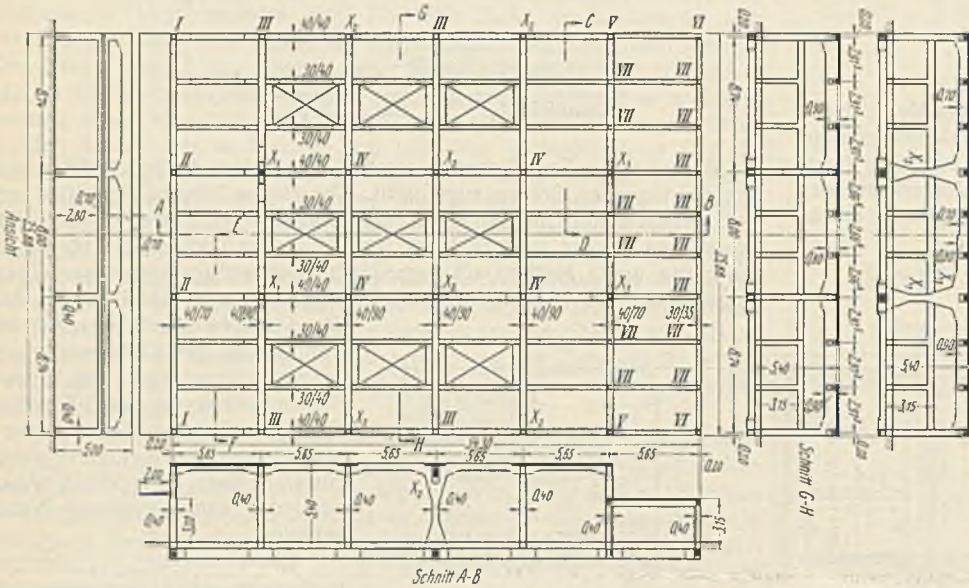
Schalungsplan, Grundriß und Schnitte.
